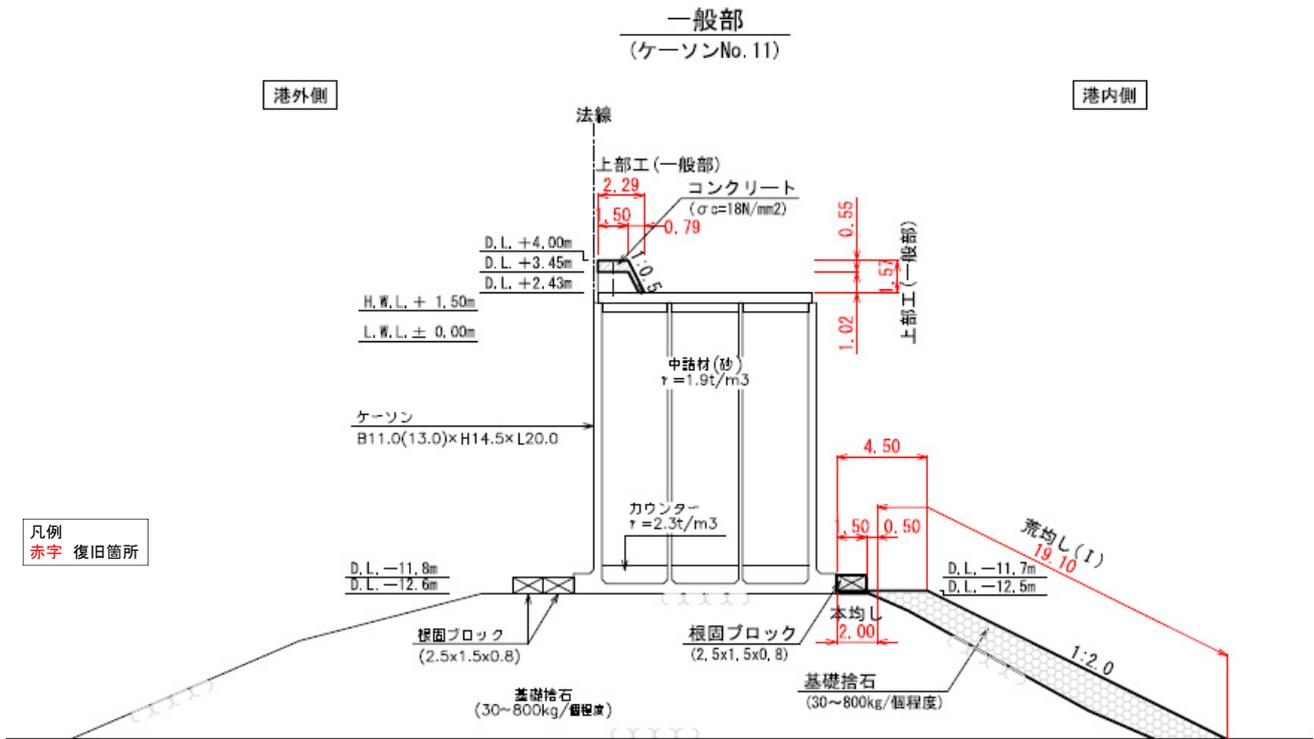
No.1 常陸那珂港区_北防波堤断面図(一般部)(復旧後)
